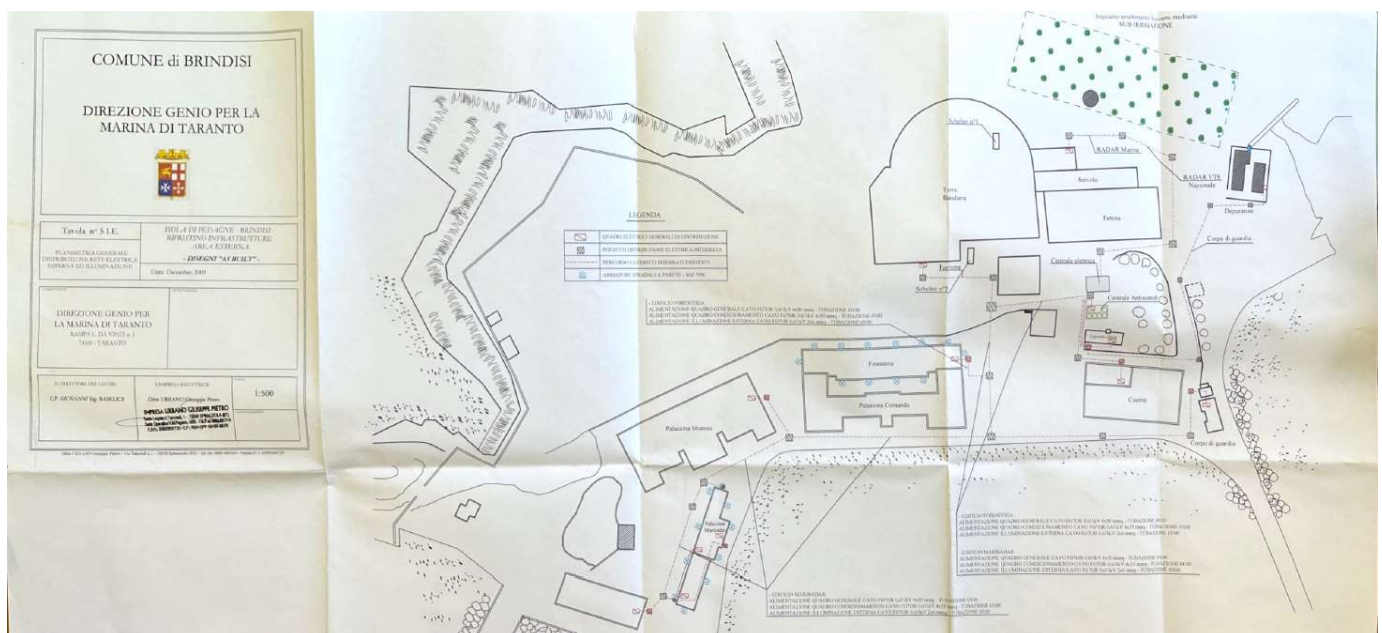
Stralcio planimetria generale distribuzione rete elettrica esterna e di illuminazione
